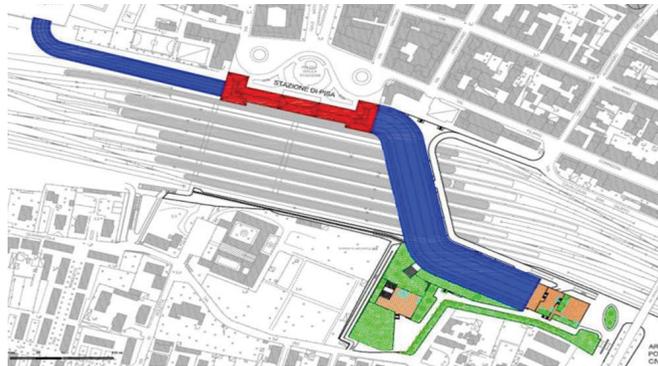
Figura I: Planimetria generale e pianta parcheggio quota 0,70m
